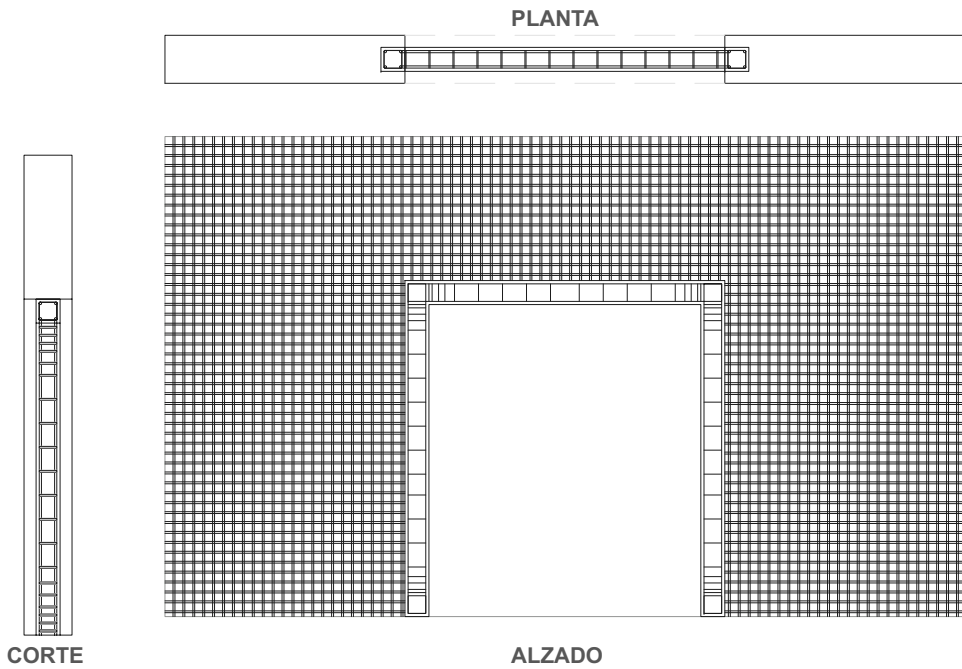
Detalle constructivo de vano en elemento estructural cartela.
